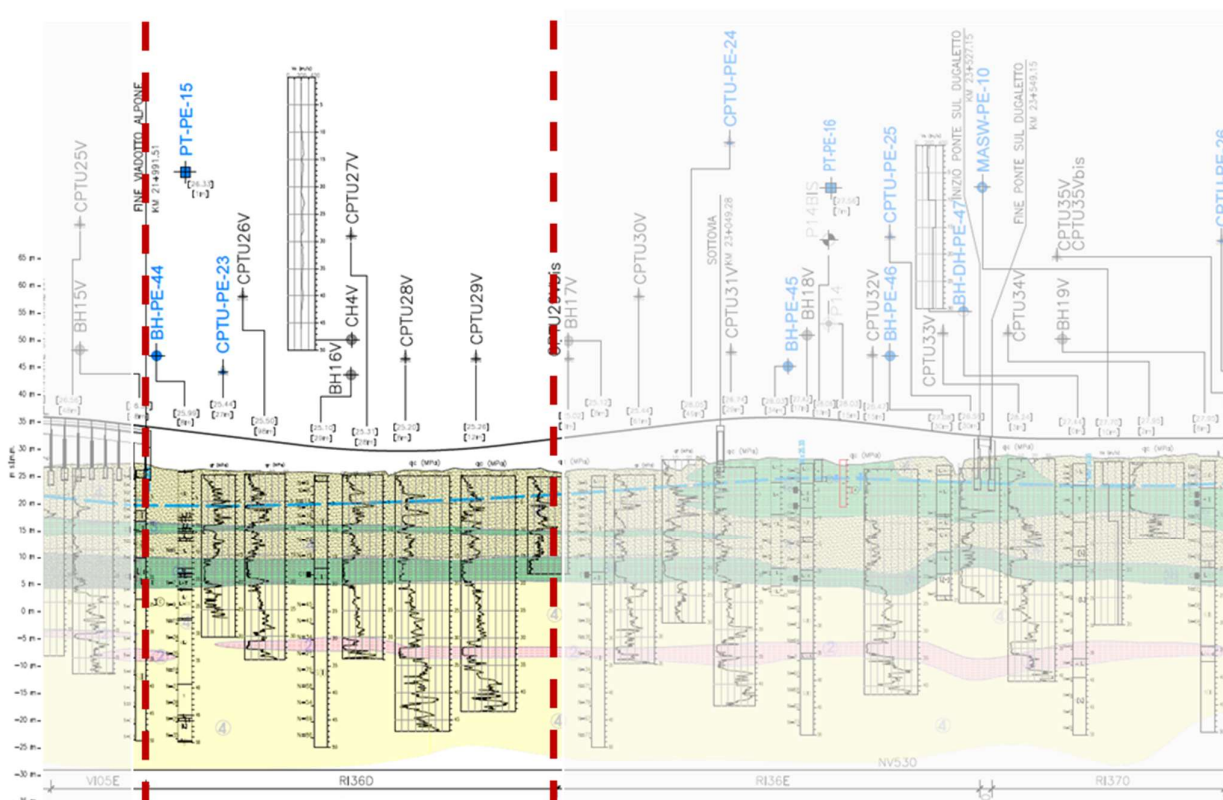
Profilo Geotecnico Rilevato RI36D, estratto dal Profilo Geotecnico Generale (Doc. Rif. [3])
